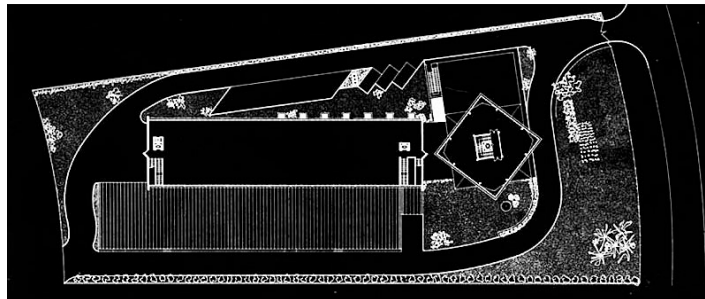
Plano general de planta del complejo de los Laboratorios Jorba.
